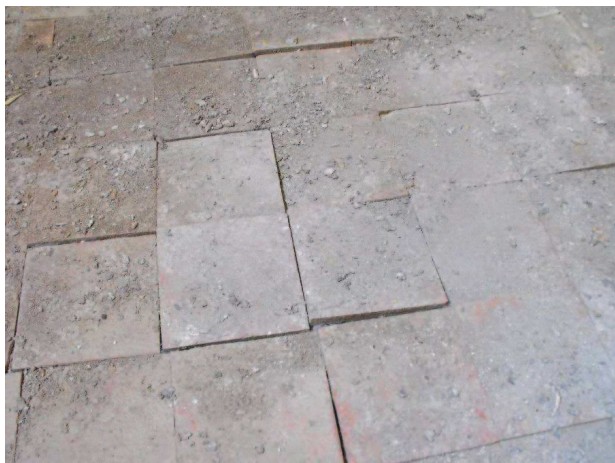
Estat dels paviments interiors de planta baixa i primera.
